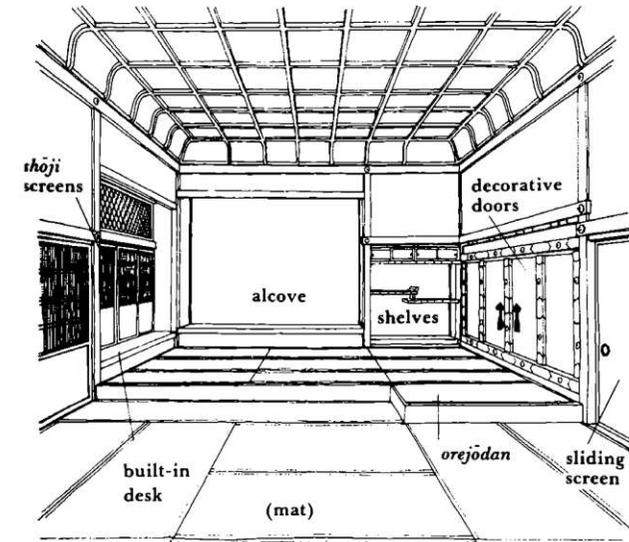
Zimmer mit typischen Shoin-Stil-Raumelemente
